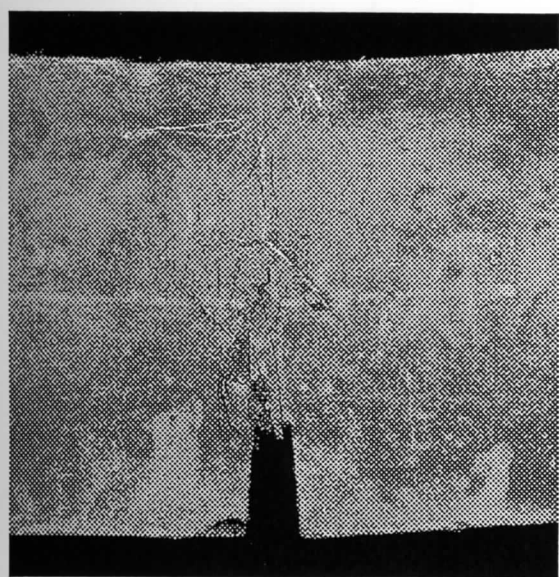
切り欠き先端のひび割れ状況
